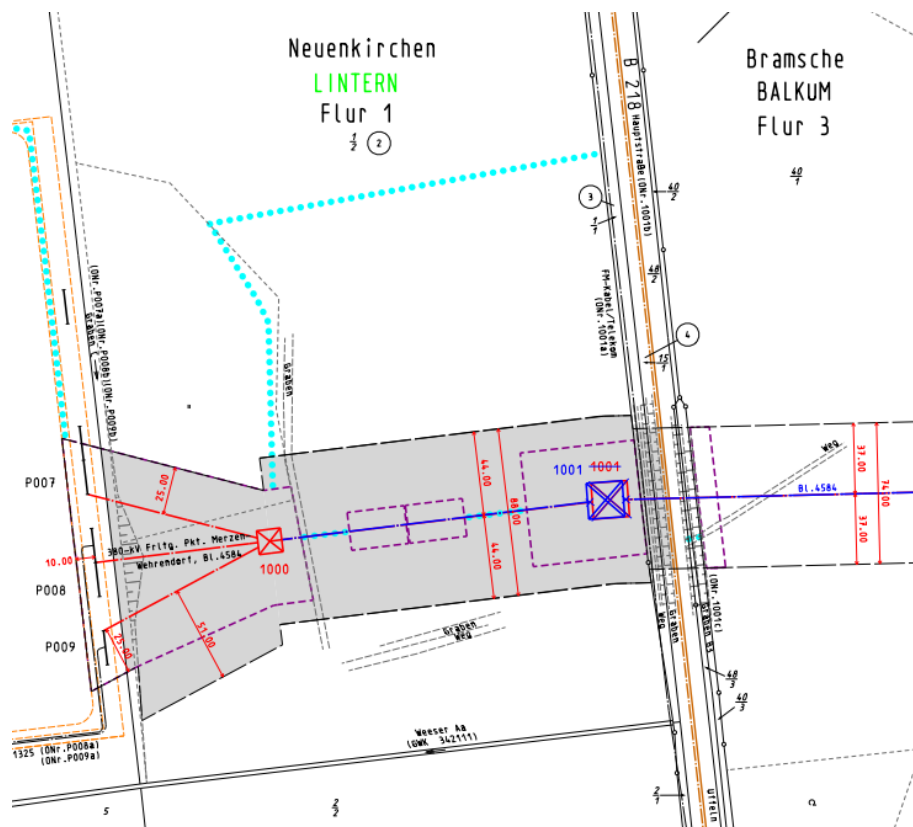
Ausschnitt aus Lageplan Anlage 7.3.2
